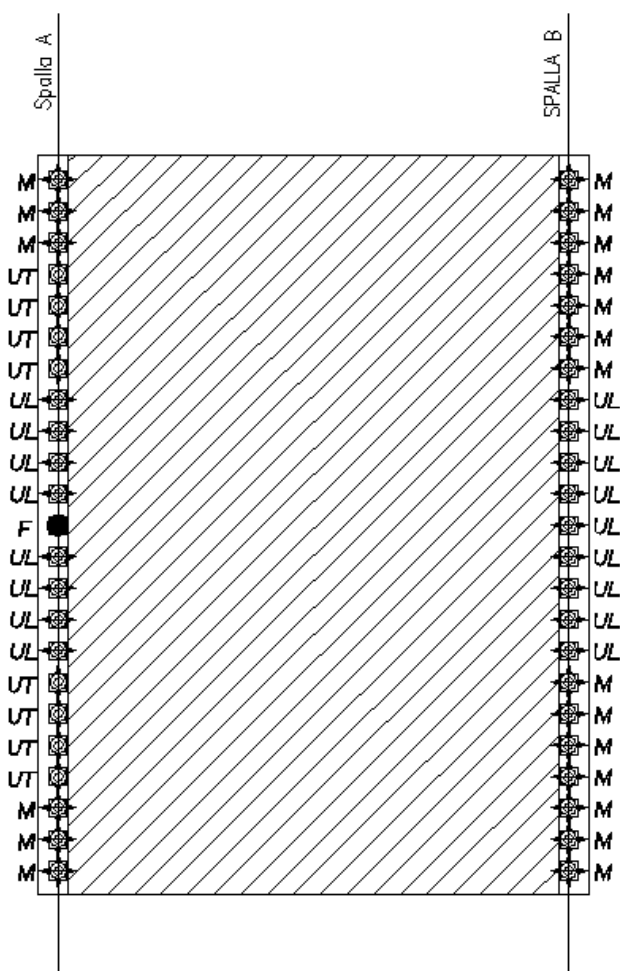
Schema disposizione appoggi – Impalcato Centrale
